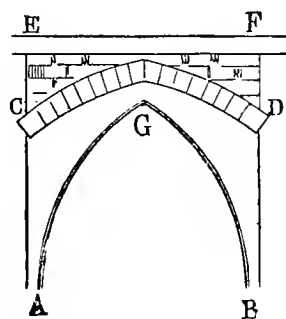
Arcs portant les chéneaux de la cathédrale d'Auxerre.
